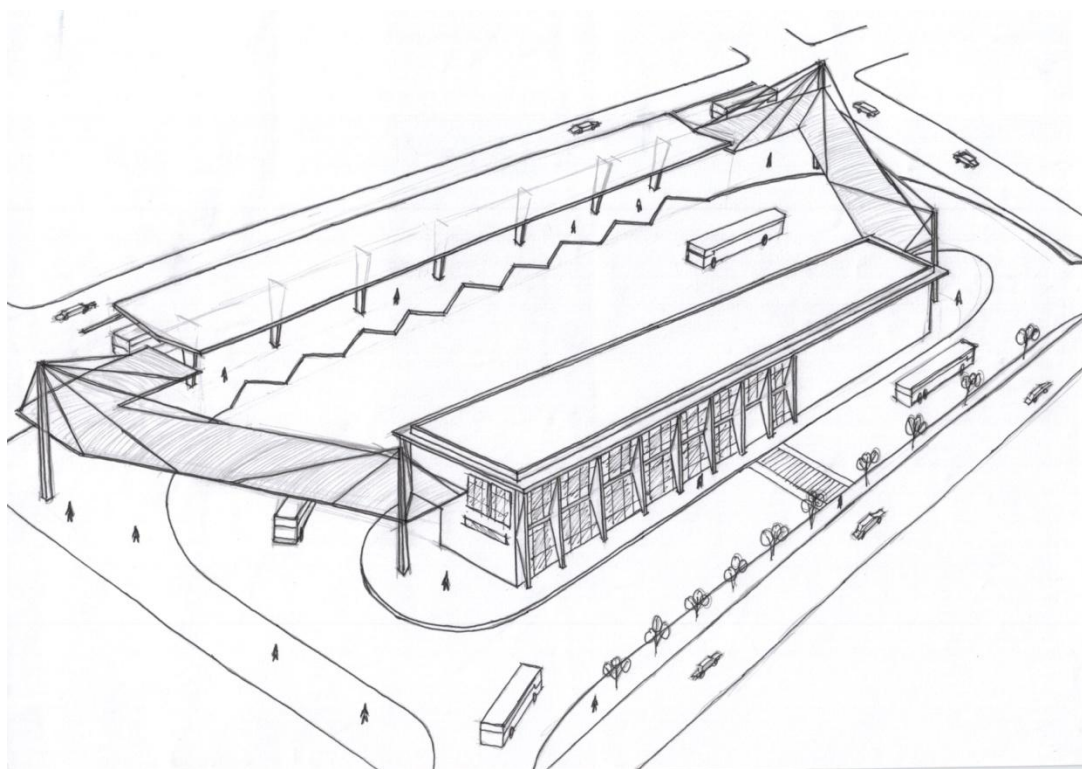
Croqui de estudo em perspectiva da Praça João XXIII.
